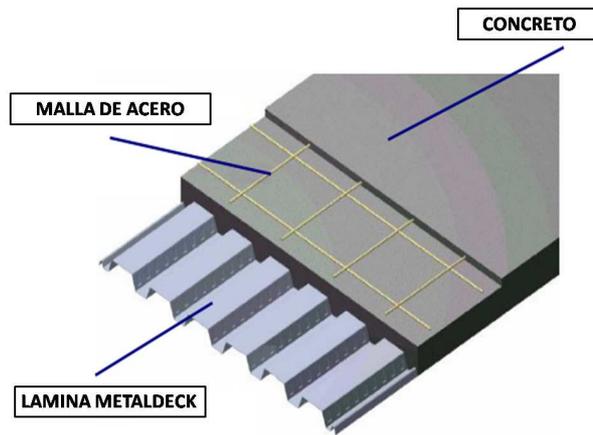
Losa con malla de acero sobre lámina METALDECK
